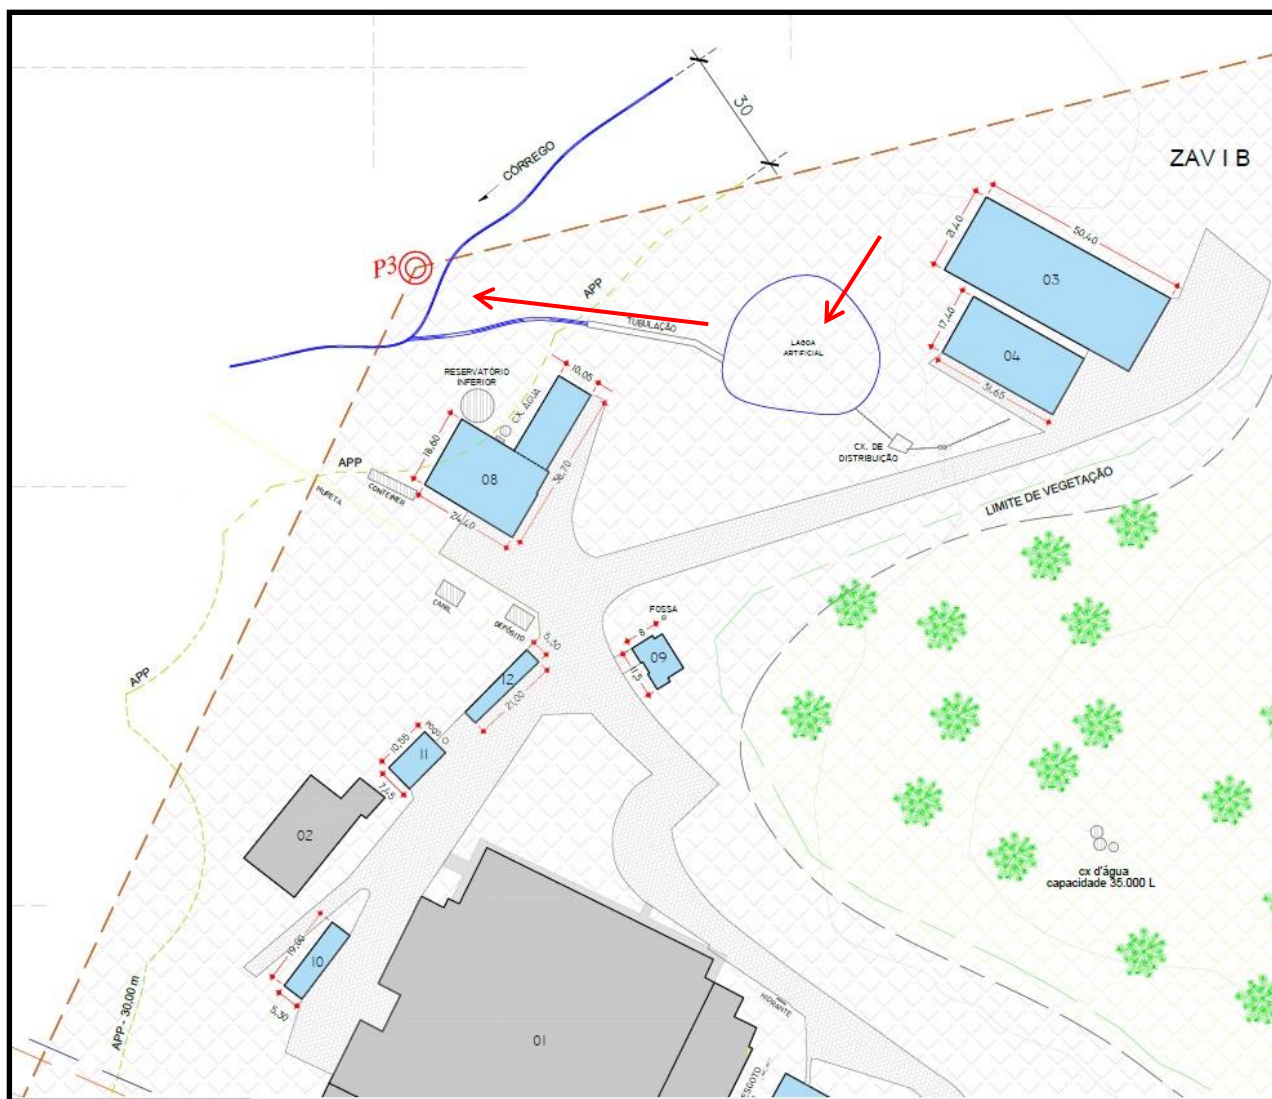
Detalhe extraído do projeto arquitetônico Prancha 01/11, demonstrando a lagoa artificial e a localização do córrego.
